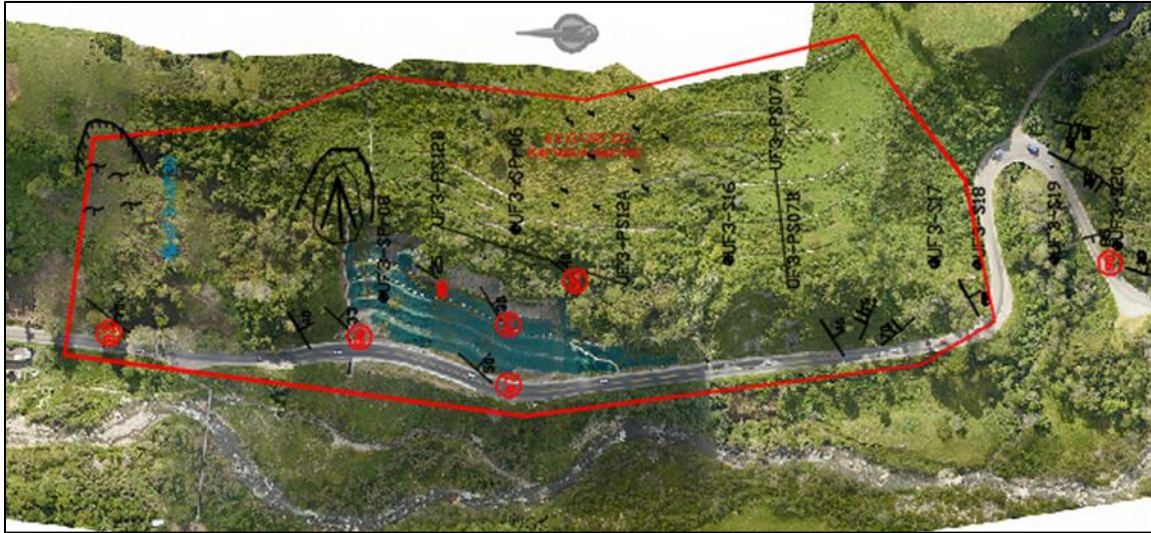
Localización y vista en planta del sitio crítico 7. (Fuente: Elaboración propia).
